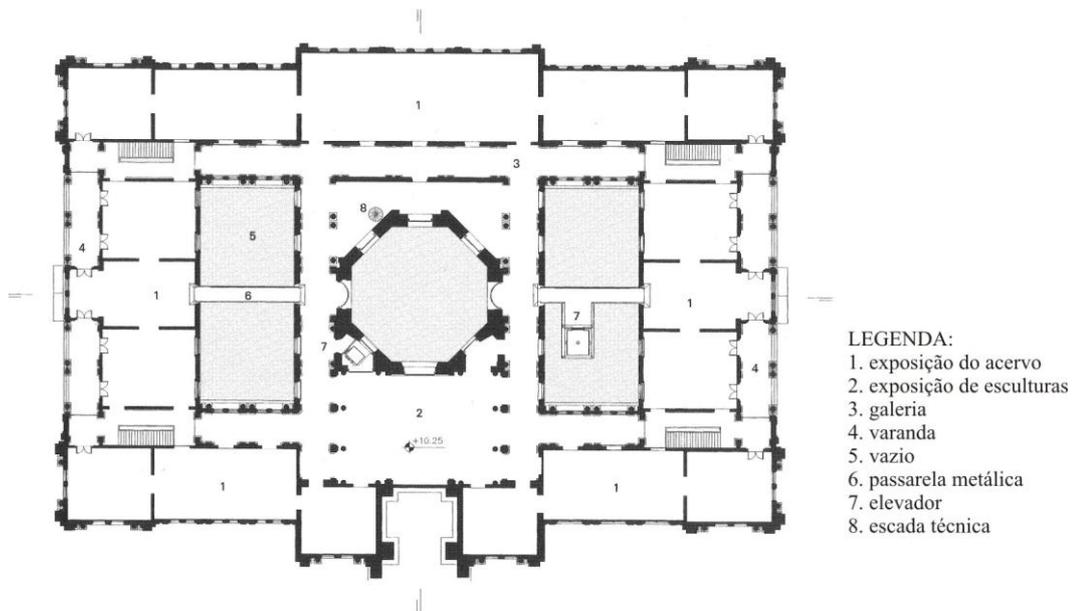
Planta do 2º pavimento da Pinacoteca do Estado de São Paulo.
